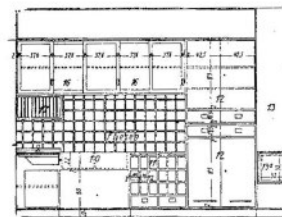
Grundriss und Wandaufbau der Frankfurter Wohnküche im Maßstab 1:50
